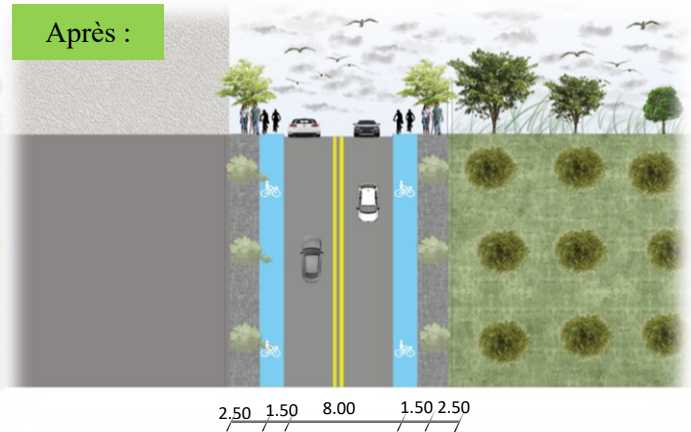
plan et coupe de la rue Mellouli Ahmed après l'intervention.
